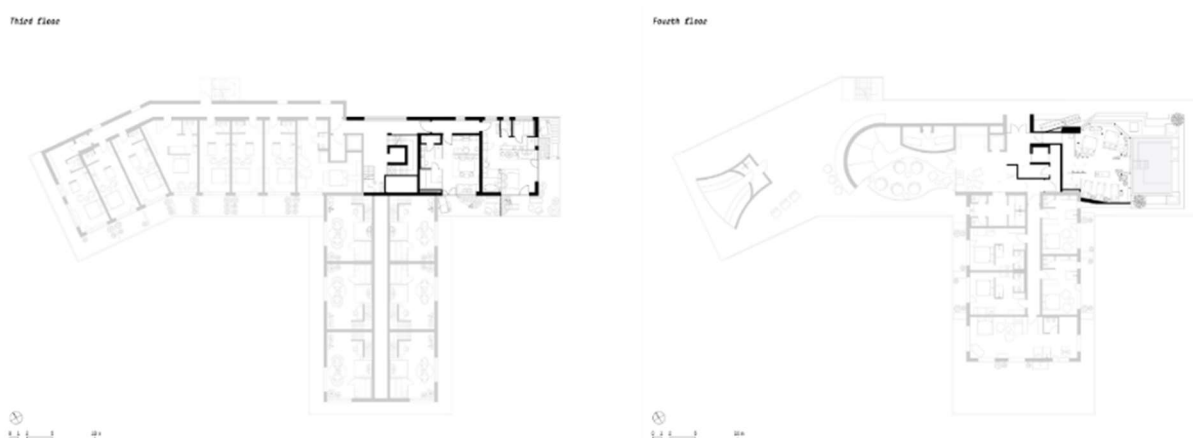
План третього і четвертого поверху будівлі [2]
